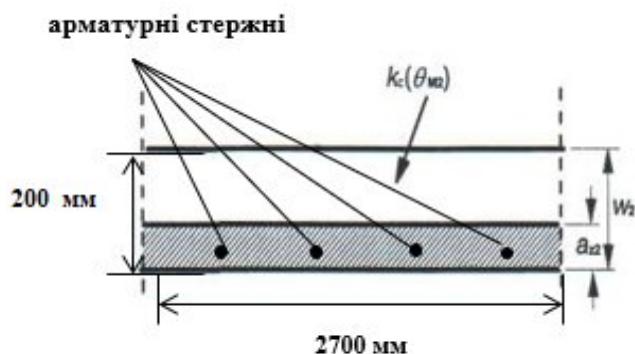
Приведений поперечний переріз залізобетонної стіни.
